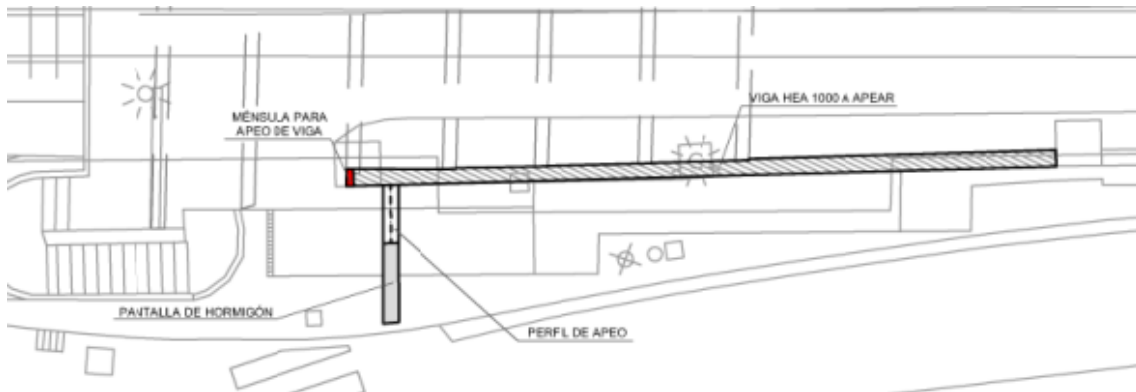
Planta de la estructura de apeo de viga principal HEA1000
